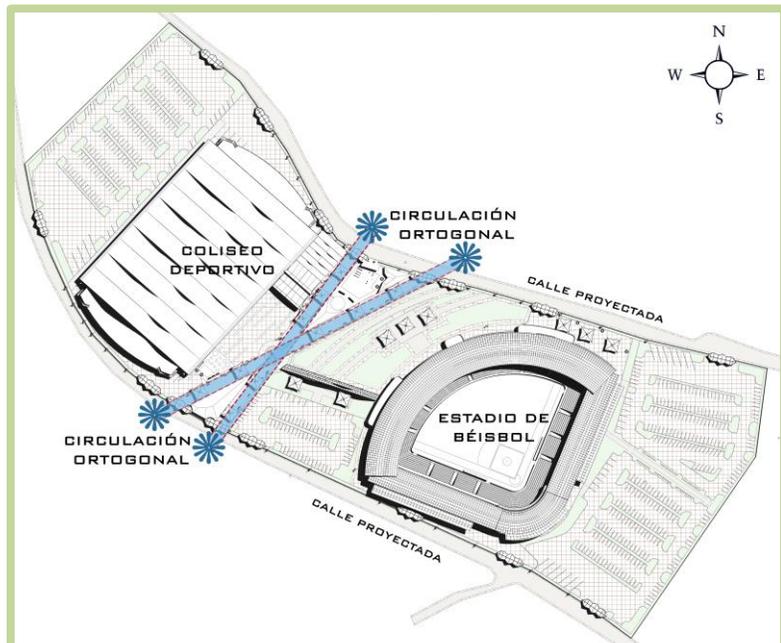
Planta de Conjunto - Fuente: Elaboración propia
